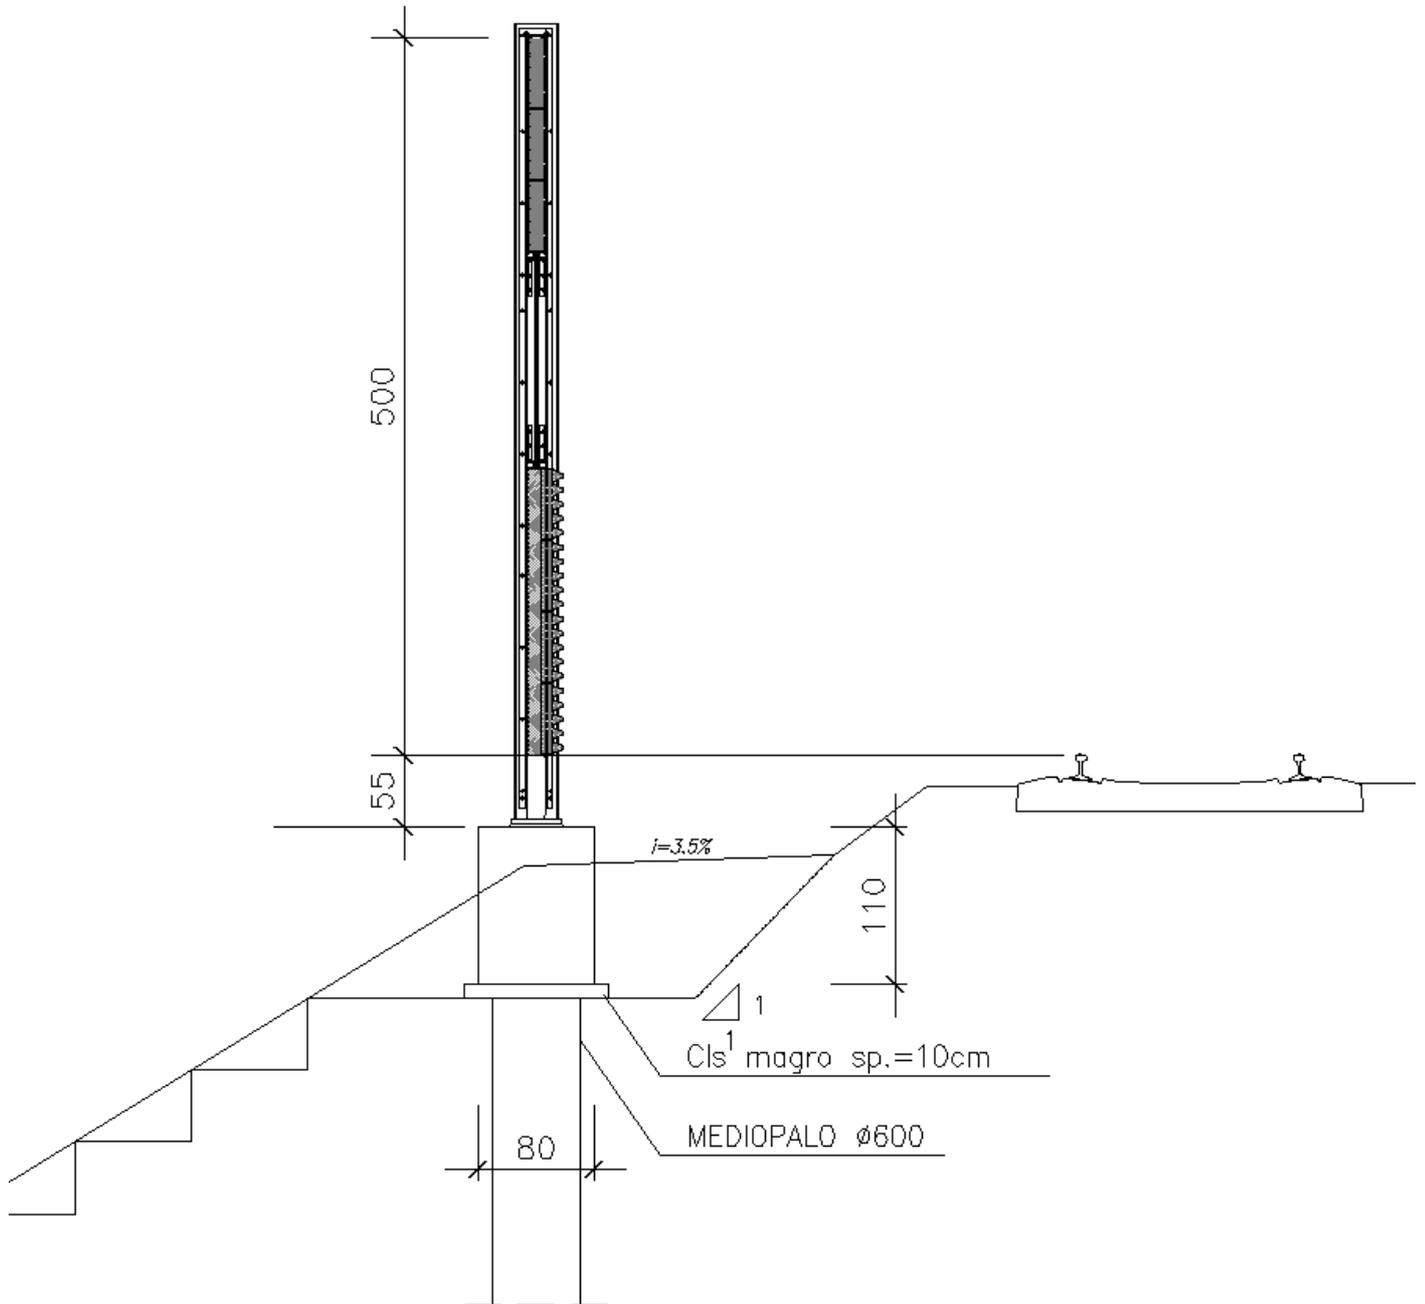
Fondazione scavalco L= 5.5 m - Sezione
